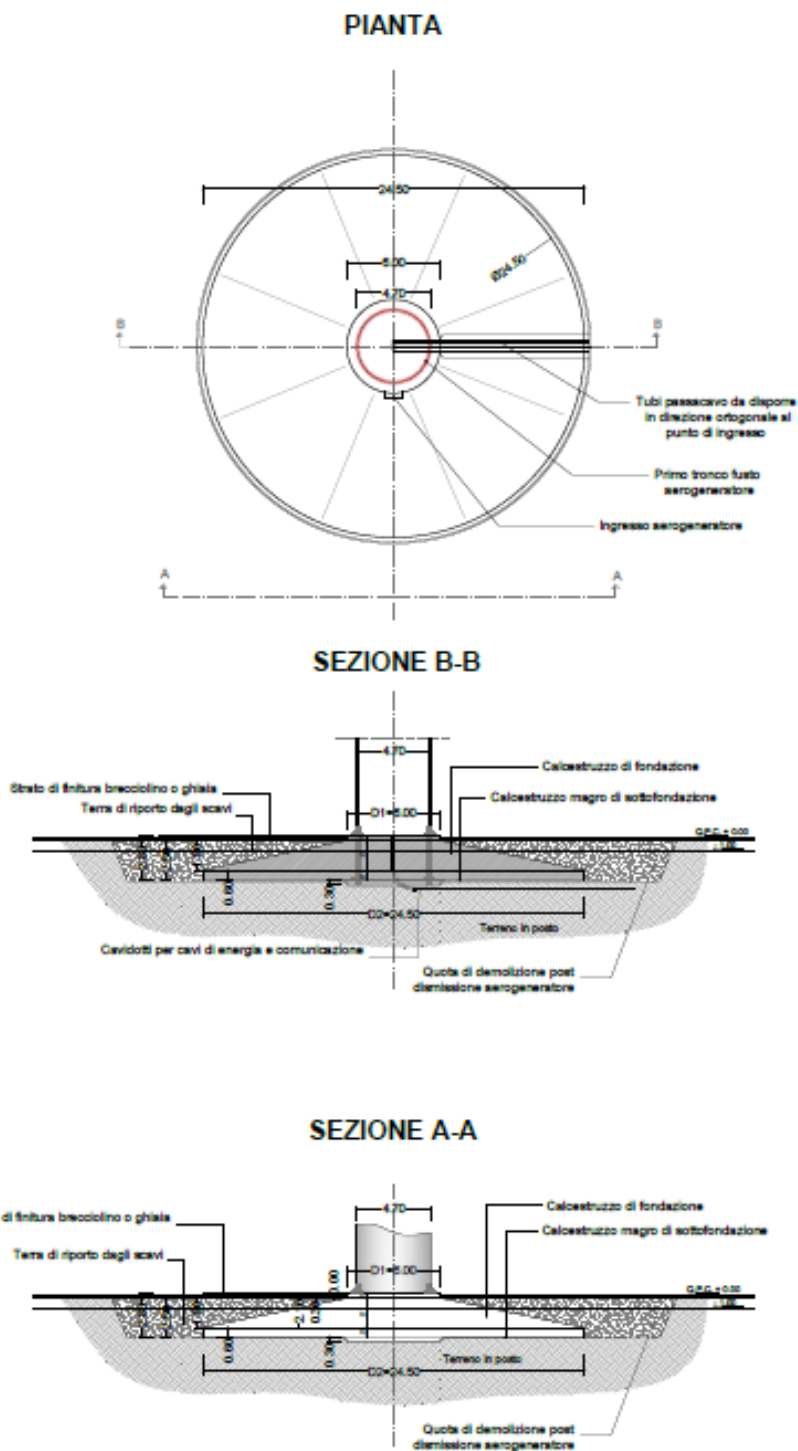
Pianta e vista della fondazione tipo dell'aerogeneratore (fondazioni dirette)
